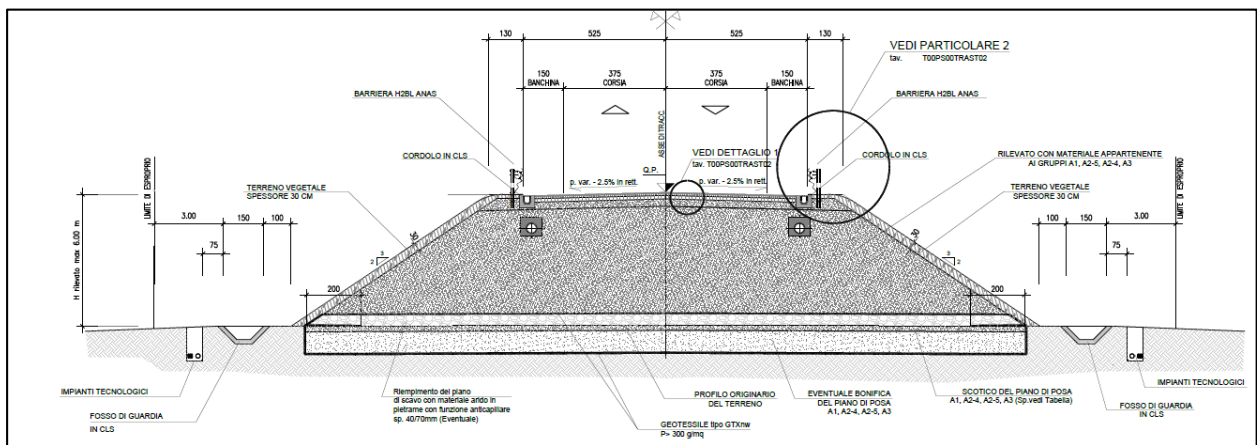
Sezione tipo C1 in rilevato con anticapillare
